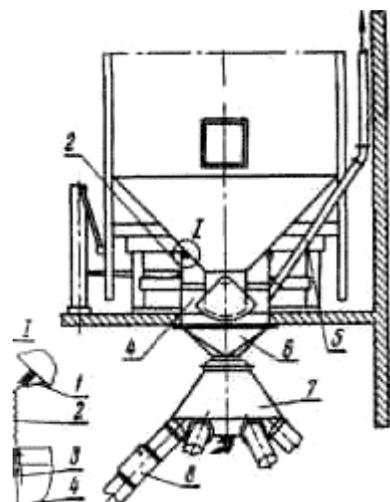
Схема обеспыливания выпуска зерна из весового ковша: 1 — фланец; 2 — кожух гибкий из прорезиненной ткани; 3 — насадок уплотнительный съемный; 4 — кожух стальной; 5 — воздухопровод; 6 — воронка подвесная; 7 — патрубок поворотный подвесной герметизированный; 8 — клапан противопыльный плотный.
